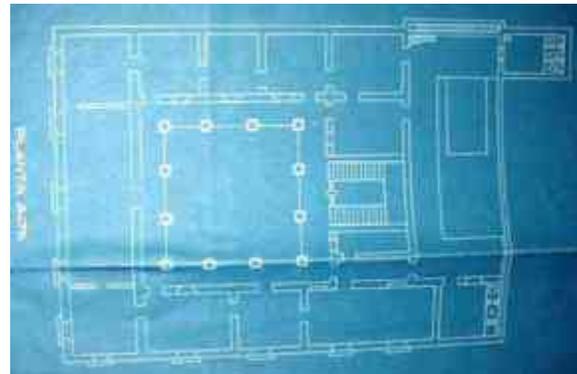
Planimetría de la casa habitación del cura Juan Bruno de Luna, como Guarnición Militar, planta alta.
